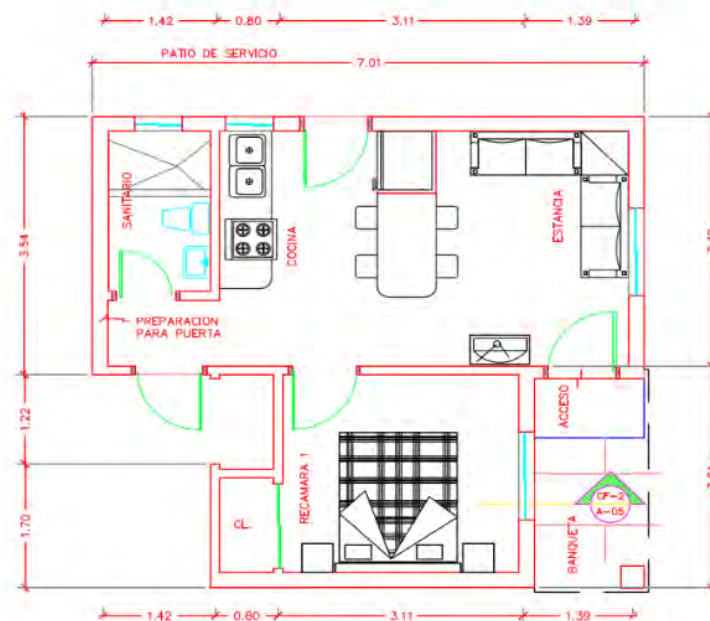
Planta Arquitectónica de vivienda típica de interés social
